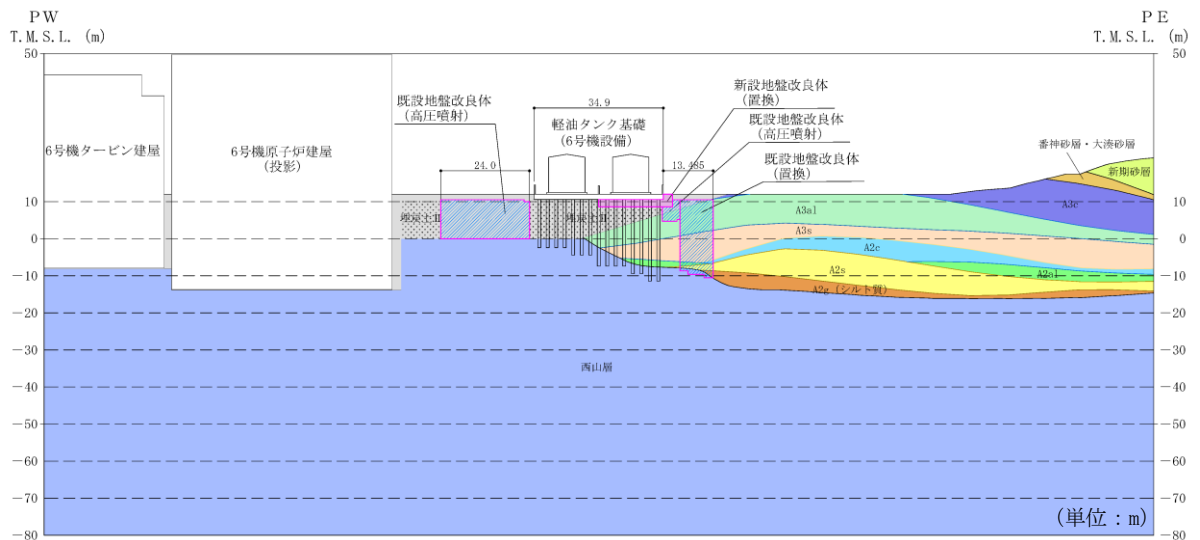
地盤改良体の配置図 (軽油タンク基礎)
